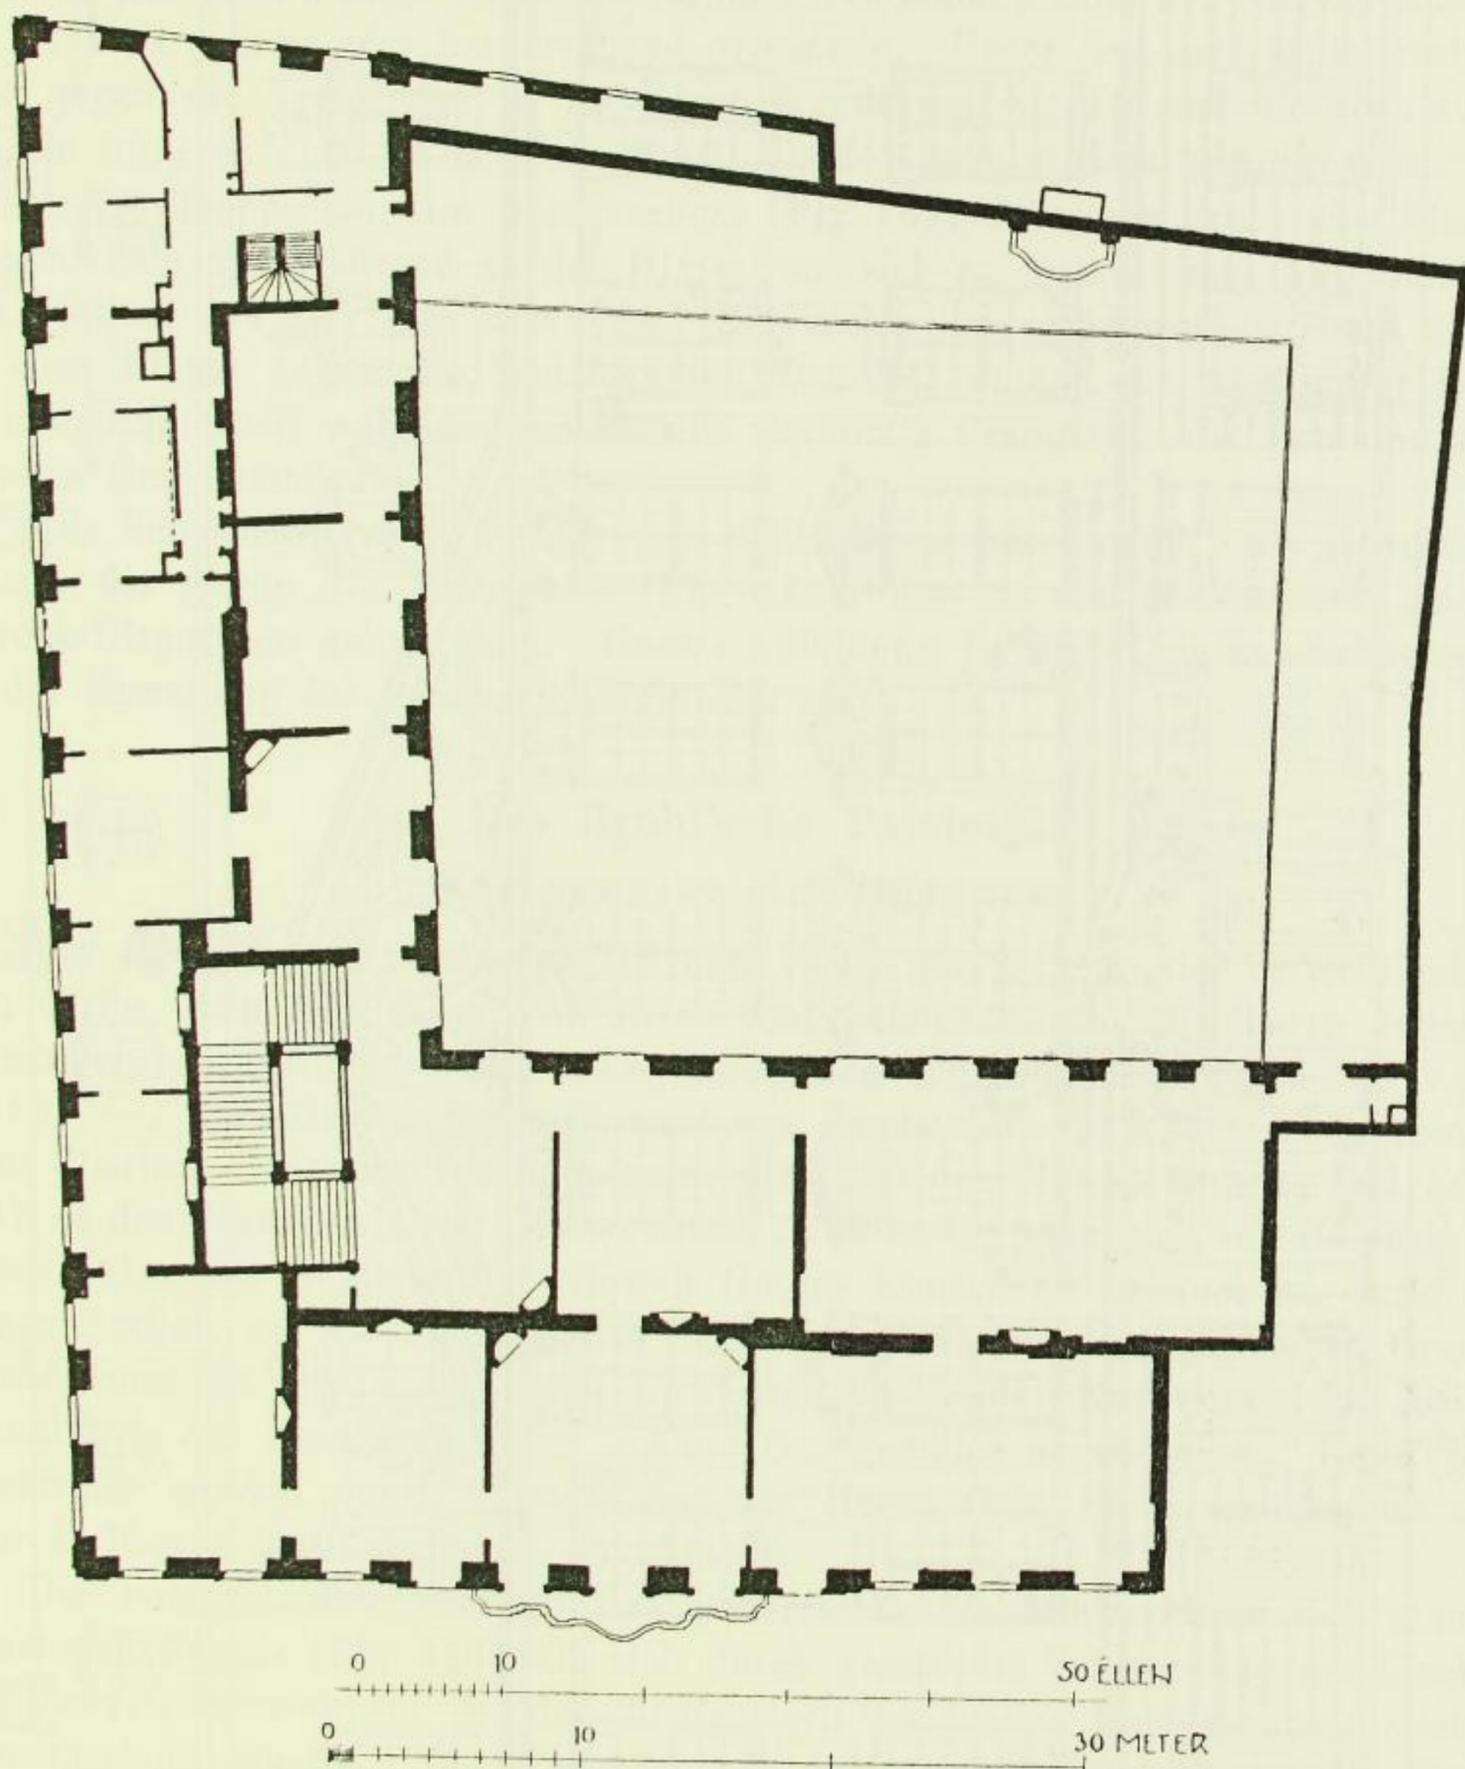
L. Rutowsky'sches Palais, Grundriss des Hauptgeschosses.
